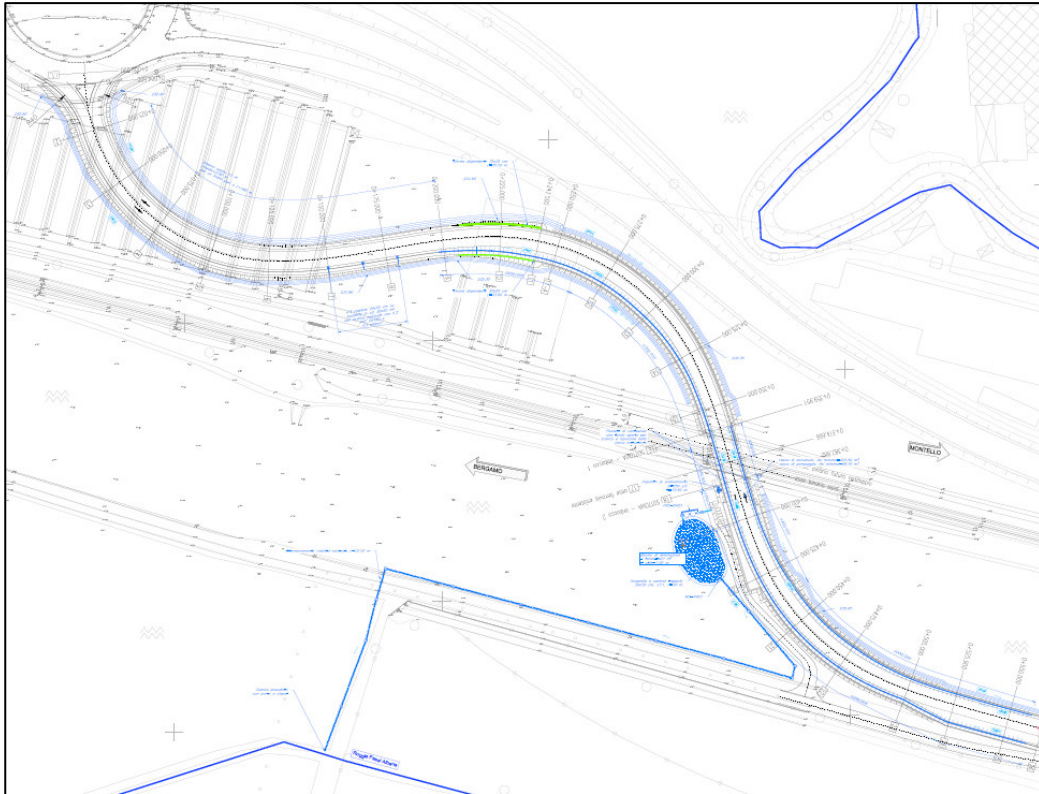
Stralcio planimetrico sistema di drenaggio.
